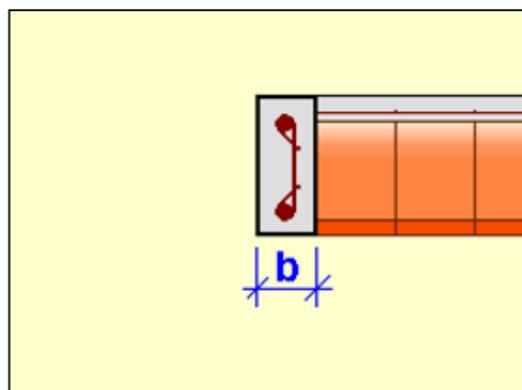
Captura imagen sección zuncho de borde tipo. Fuente: CYPE
